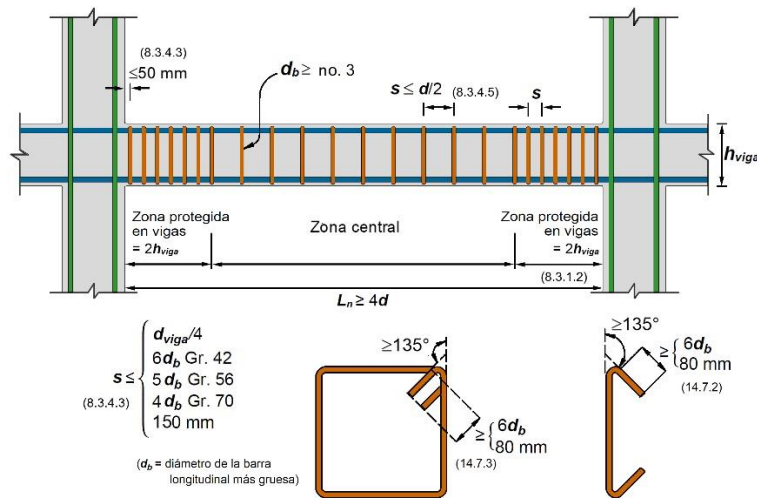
Detallado de vigas de ductilidad alta
